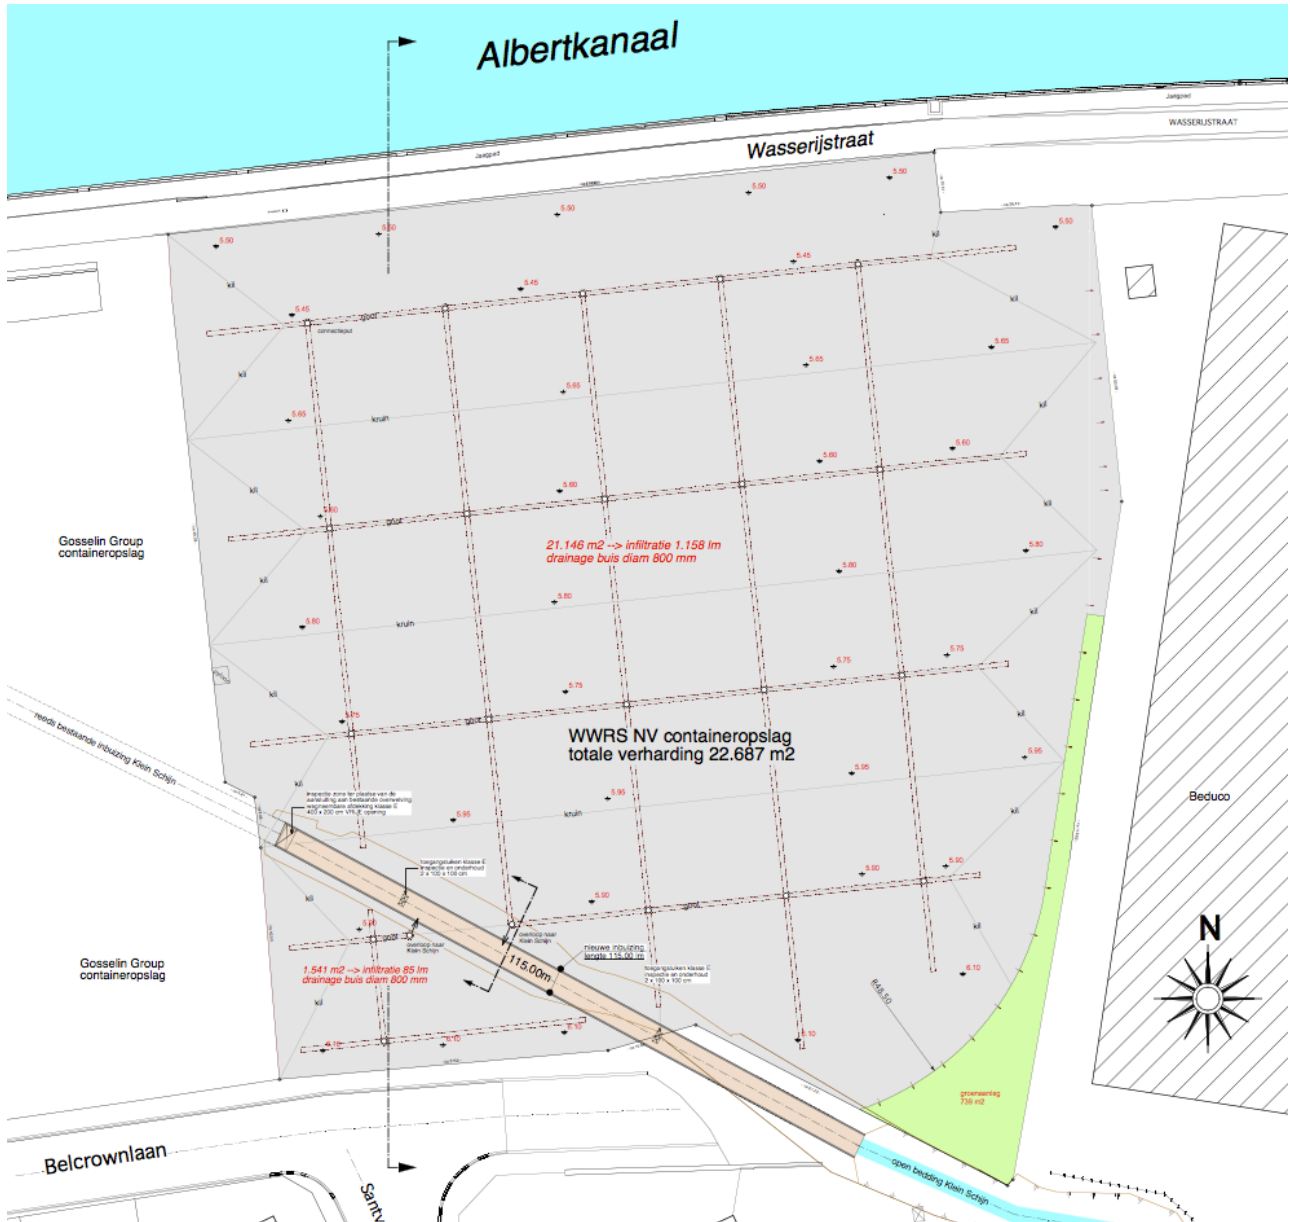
PLAN 4 Geplande toestand. © STYLUS architecten
